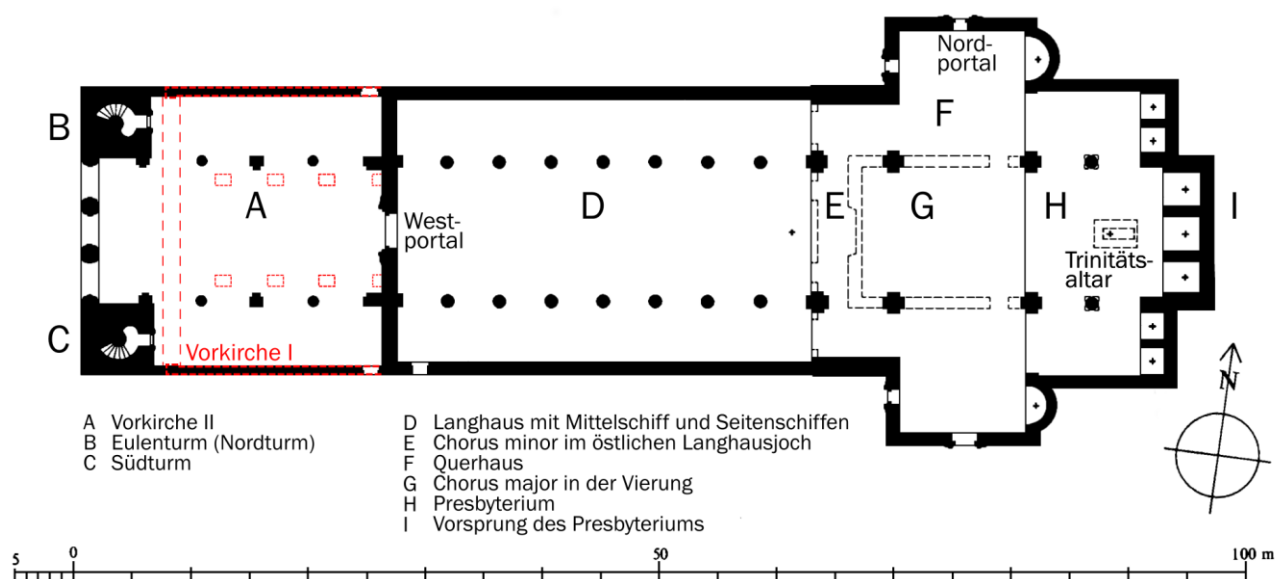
Der Grundriss der Peter-und-Pauls-Kirche
